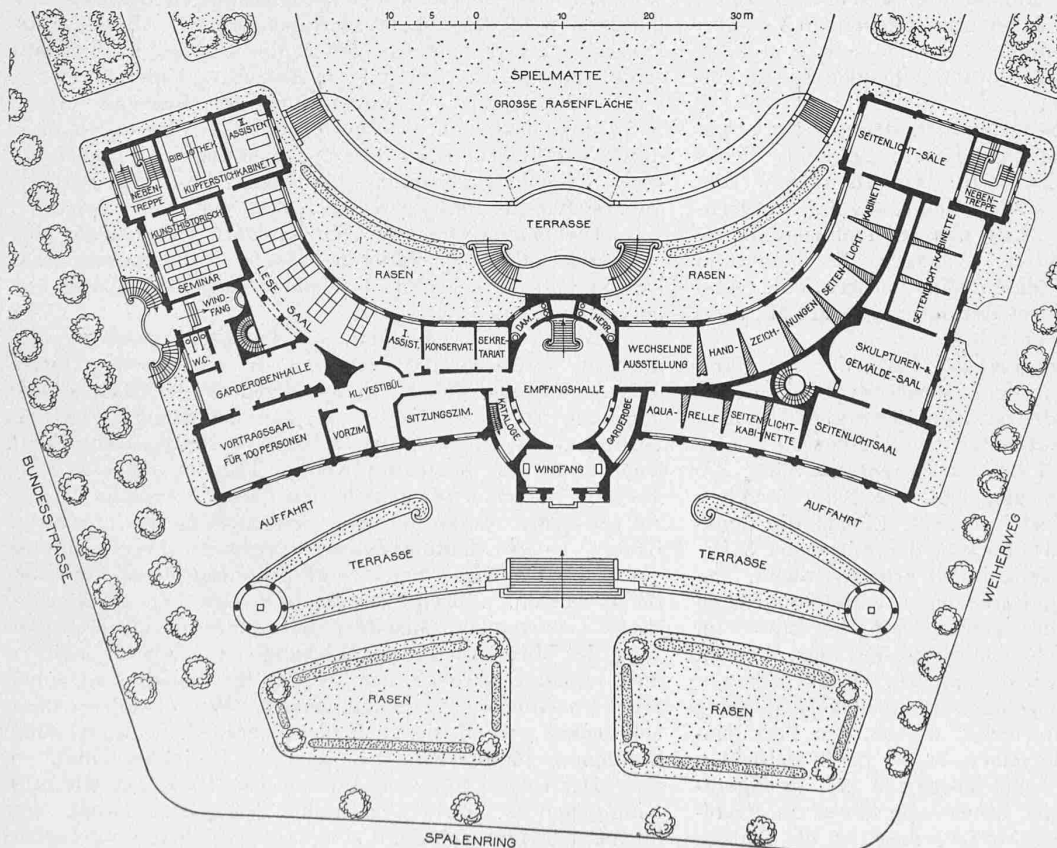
Grundriss des hochliegenden Erdgeschosses. — Masstab 1:400.
